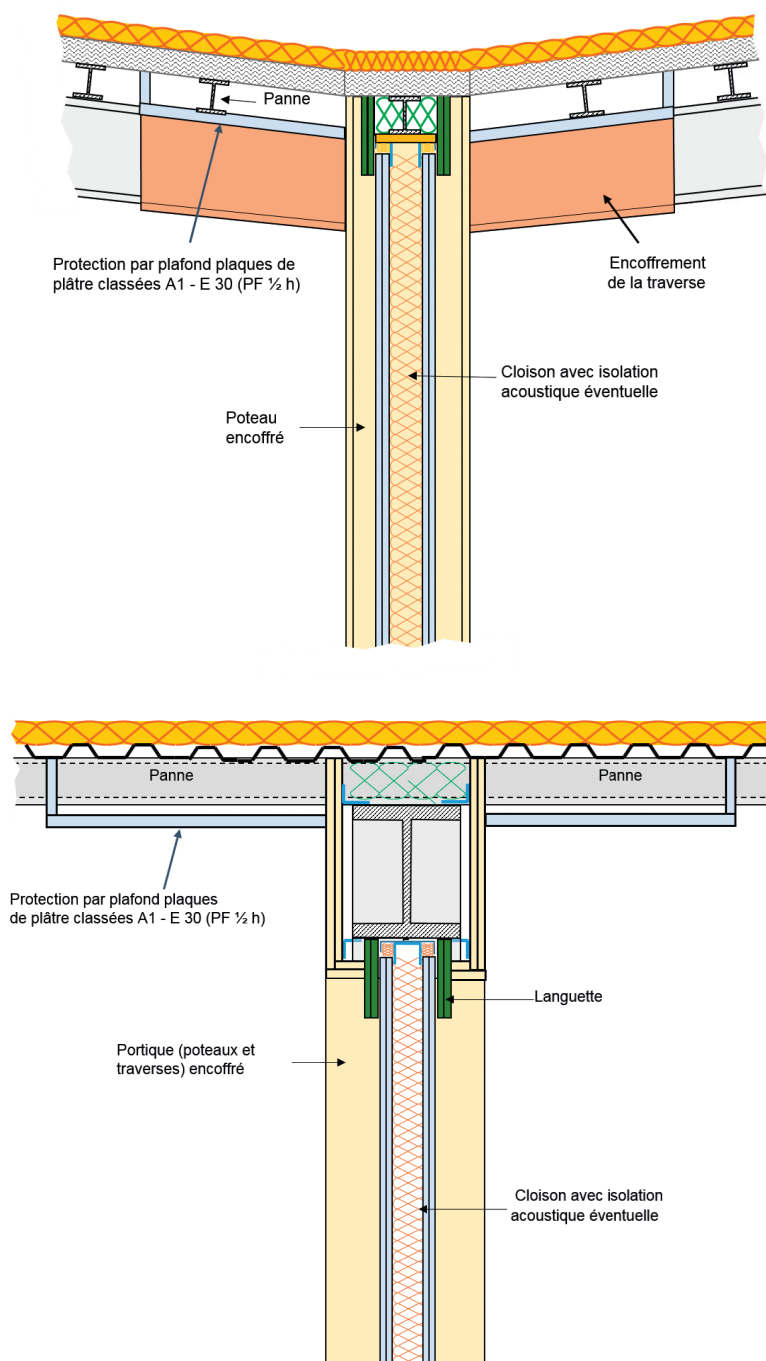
Exemples de protection par plafond plaques de plâtre E 30
